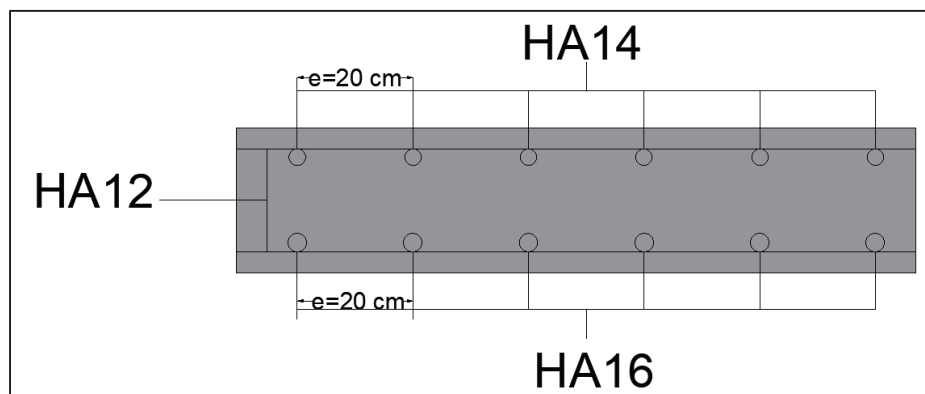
Ferrailage de la dalle (coupe transversale)
